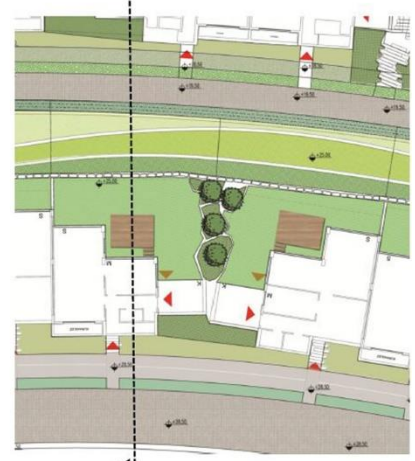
Çalışma alanı konut bahçeleri plan görünümü (Orijinal, 2022)
